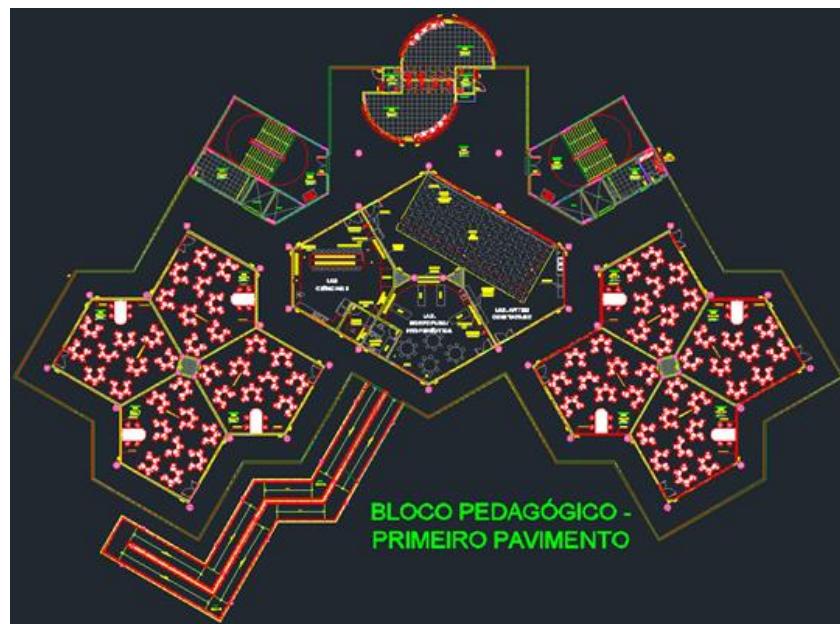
Planta do 1º pavimento do Núcleo Pedagógico CJA UFSB. Fonte: Setor de Projetos/ DINFRA/ PROPA UFSB.
